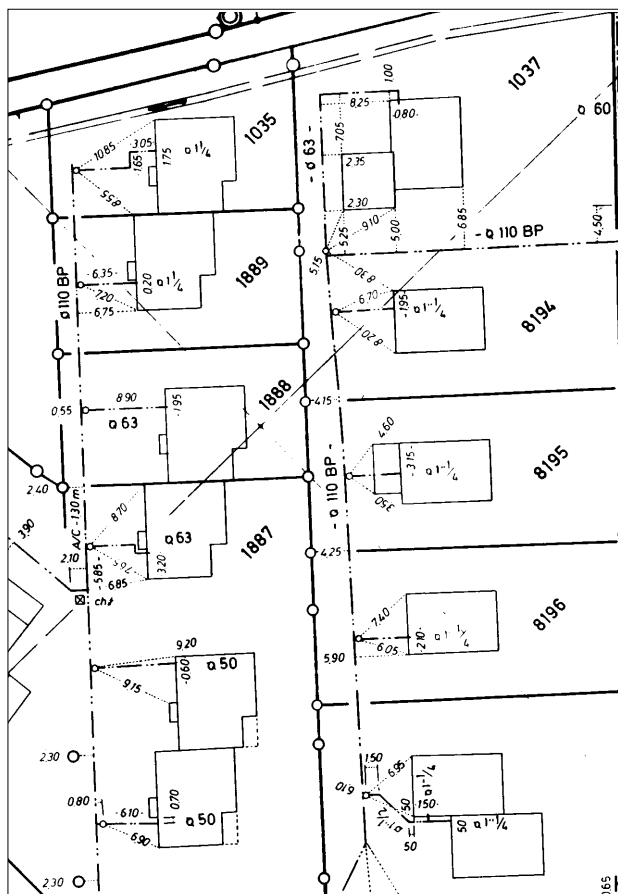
Exemple d'un plan cadastral avec le réseau de gaz.
